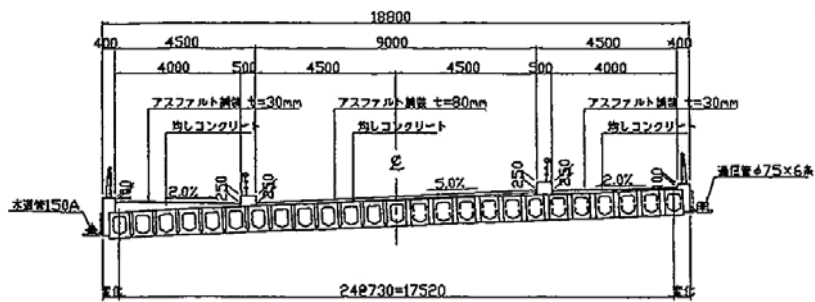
(1) 橋梁一般図(南沢川橋)
